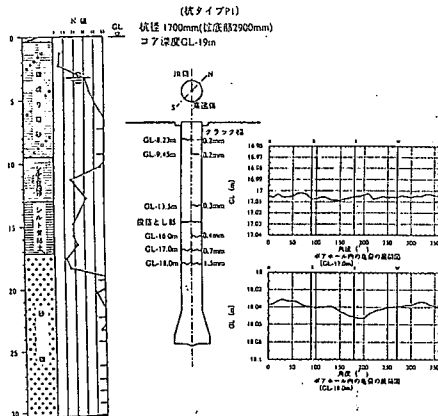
上載荷重の無い場所打ち杭のひび割れ損傷
